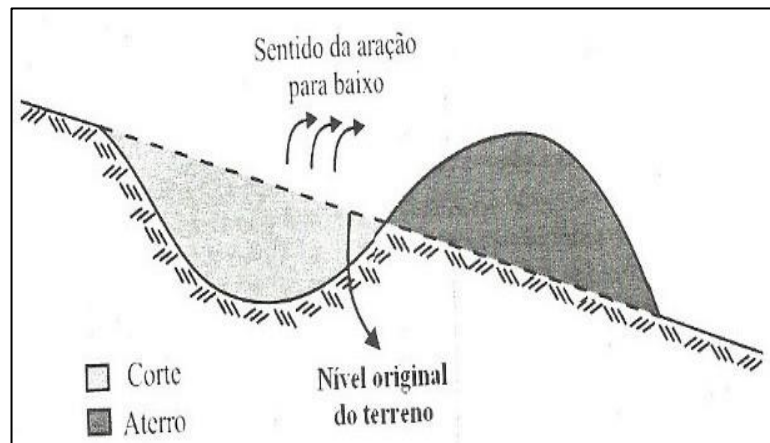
Perfil esquemático de um terraço tipo Nichol's
